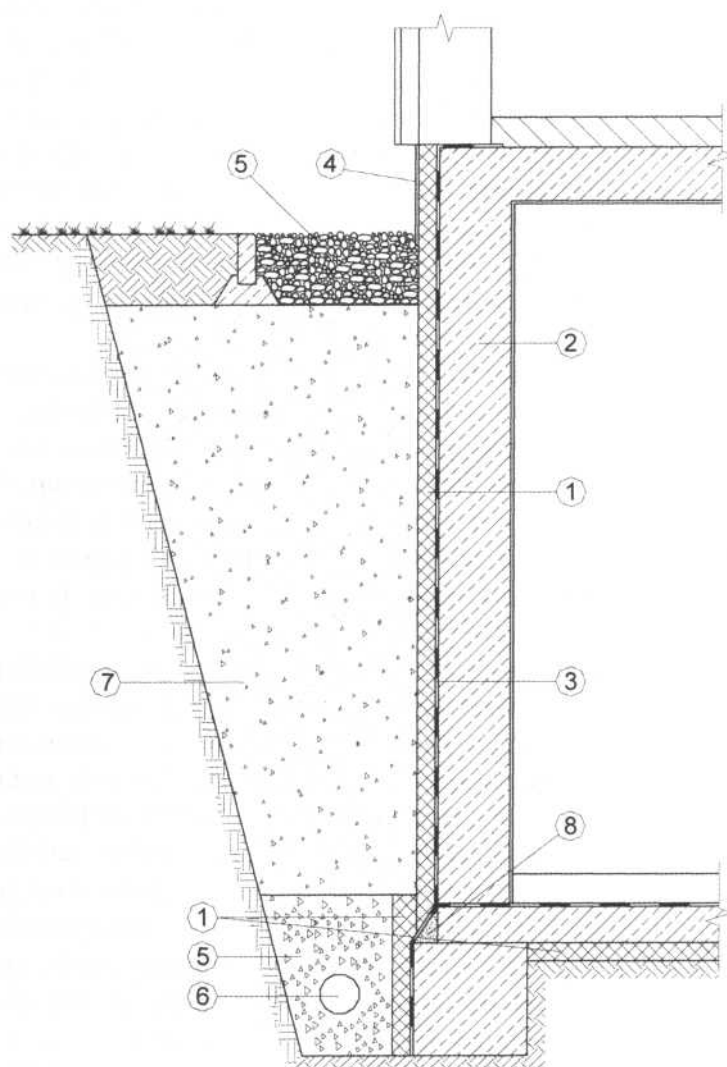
Устройство наружной теплоизоляции ограждающих конструкций подземных частей сооружений
